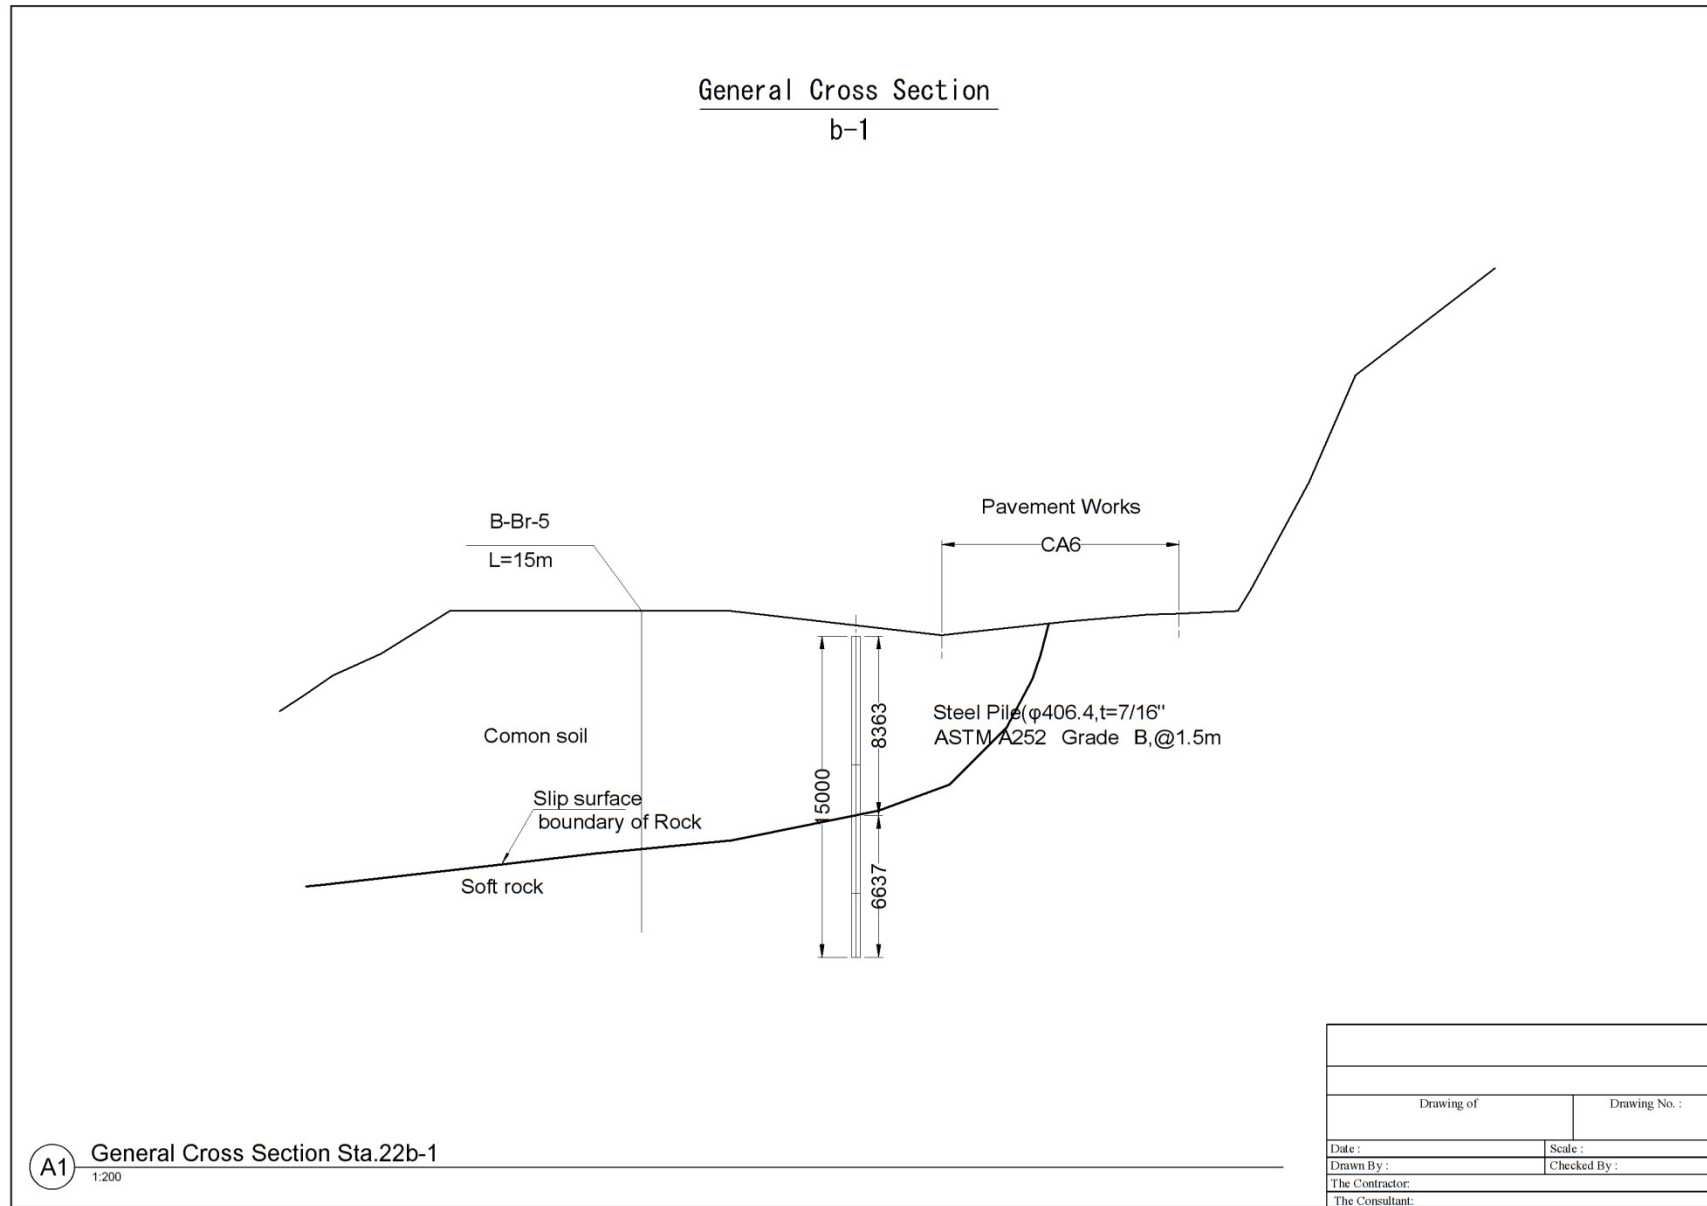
Sta.22 b-1 Vista estándar de la sección transversal (Sin escala)
